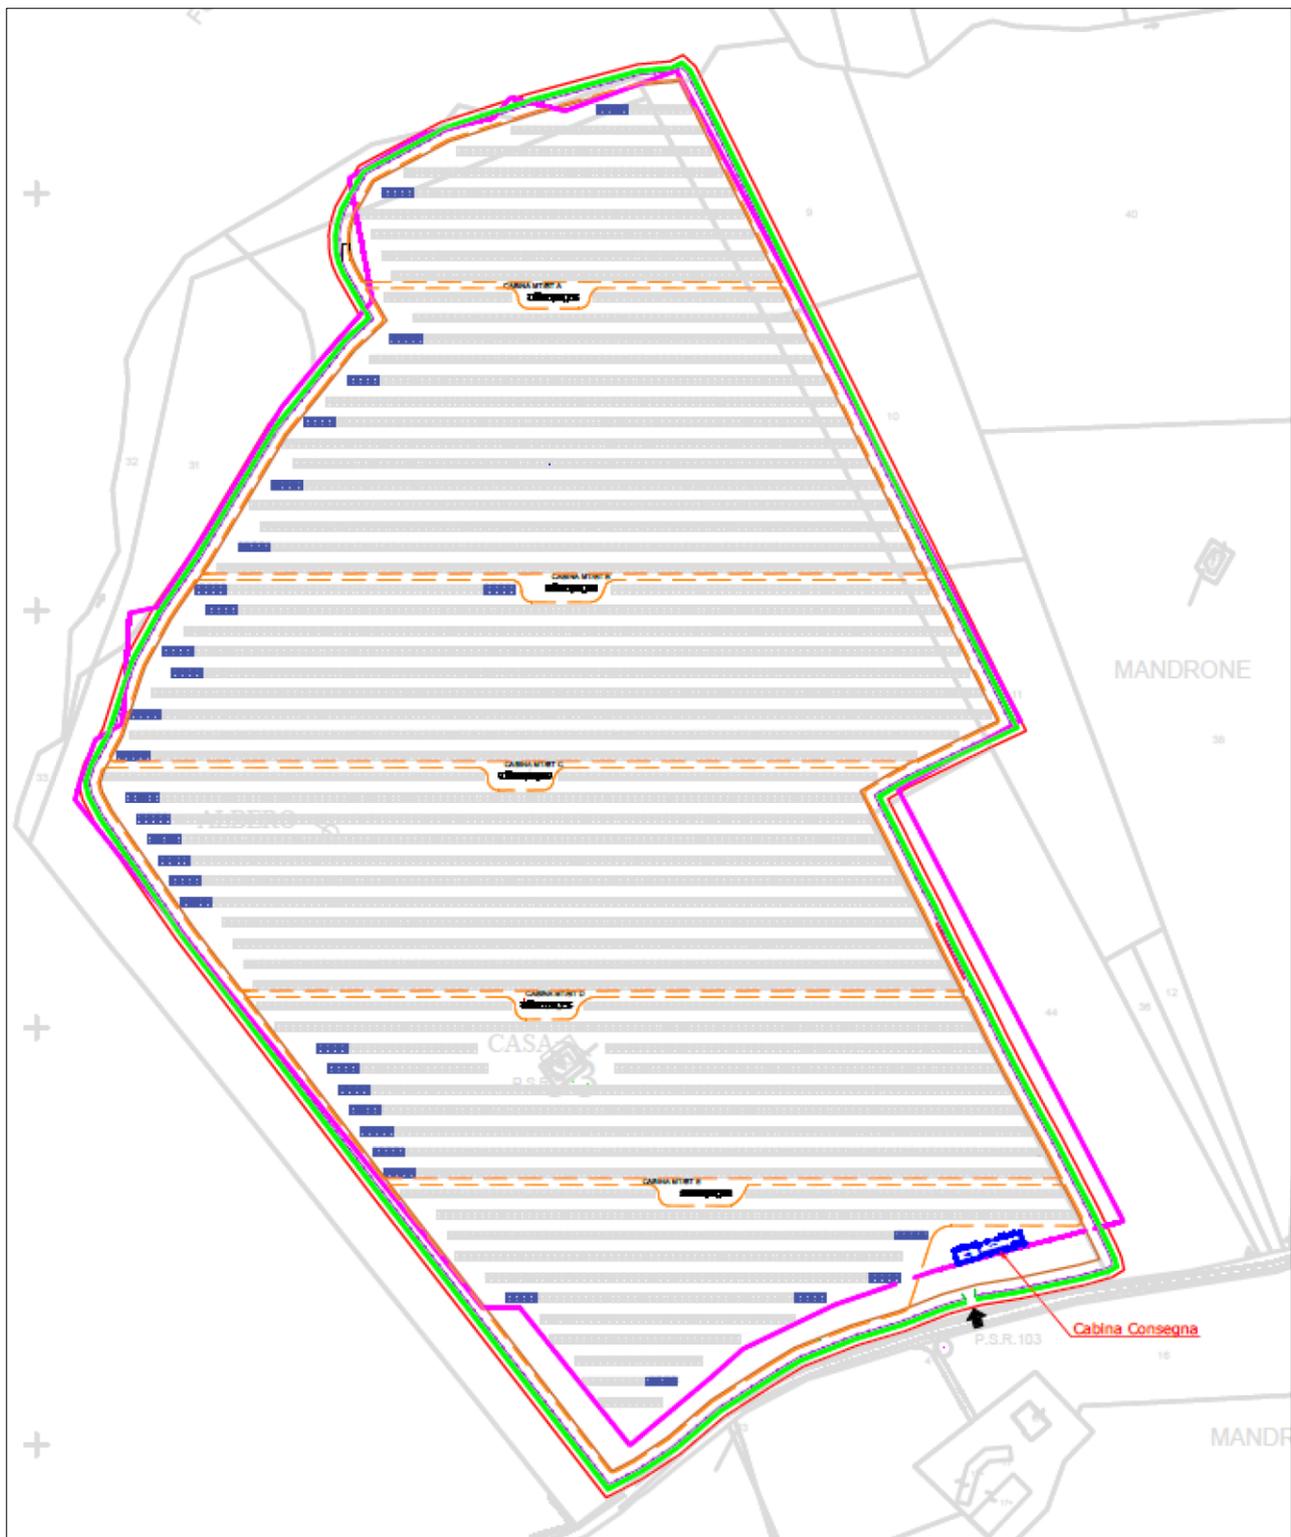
il layout di Rotello 2 (fuori scala). Anche questa planimetria, in scala adeguata e ben consultabile, è negli elaborati progettuali.
